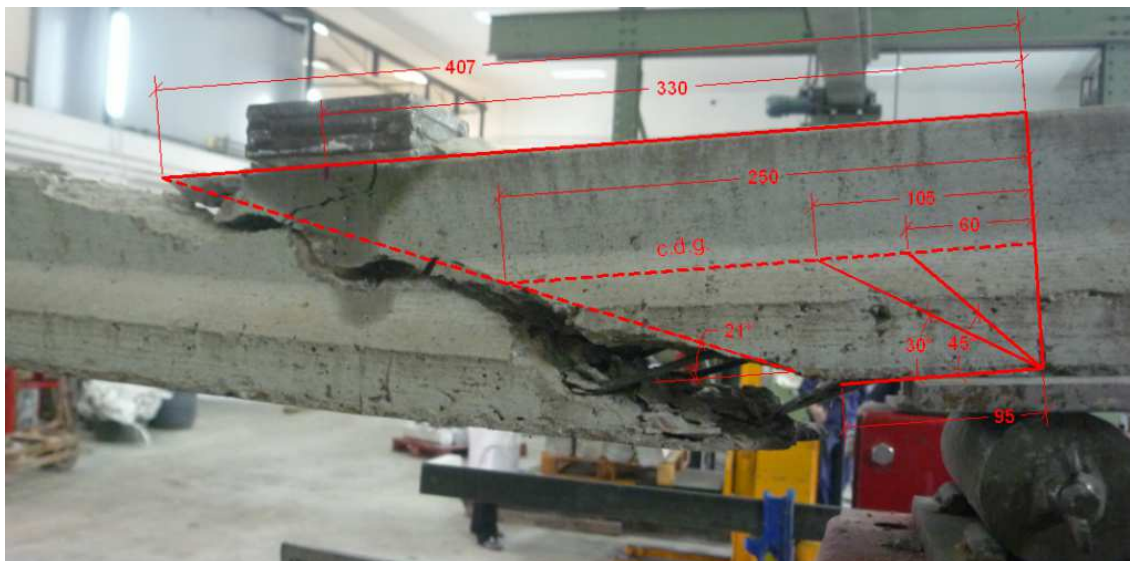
b. Rotura por cortante en vigueta aislada VP04 (T-11-5) All-pg.597
